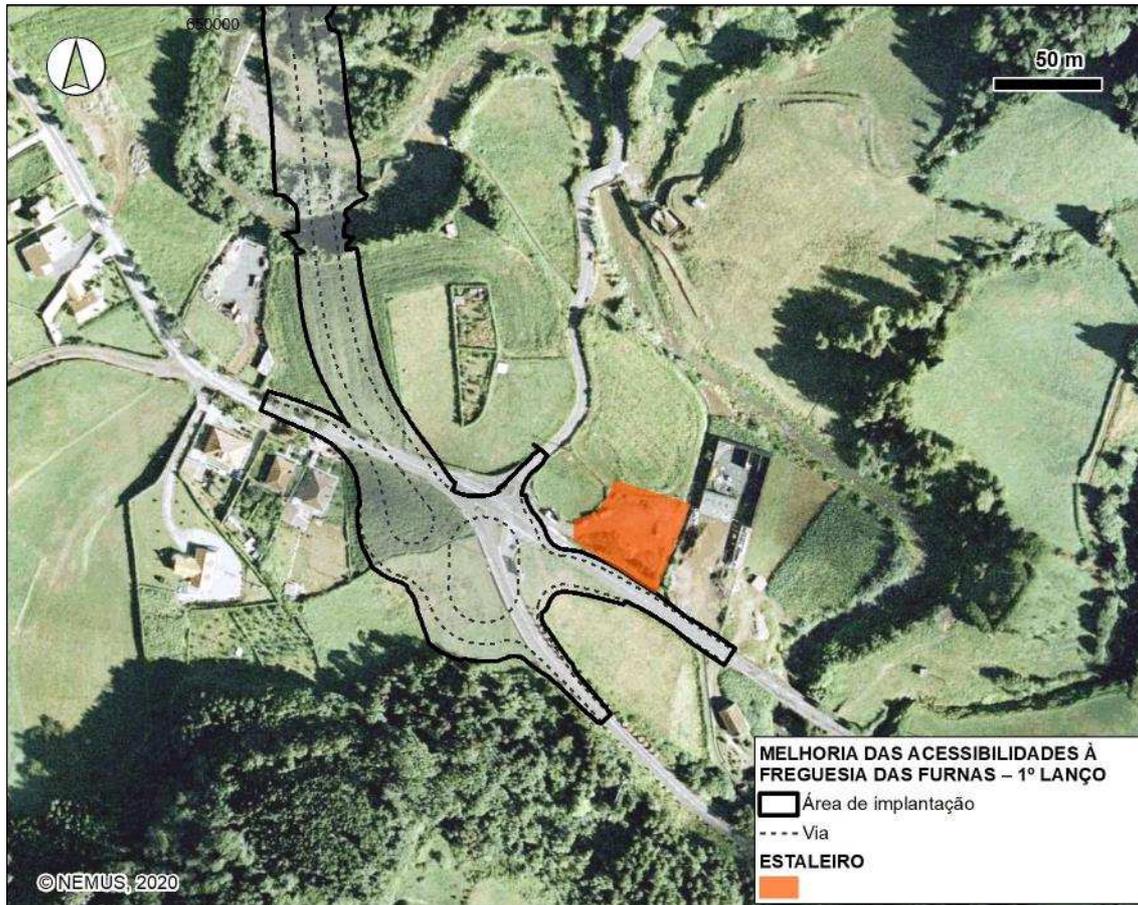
Localização para o estaleiro da obra e de outras instalações provisórias de apoio à obra
